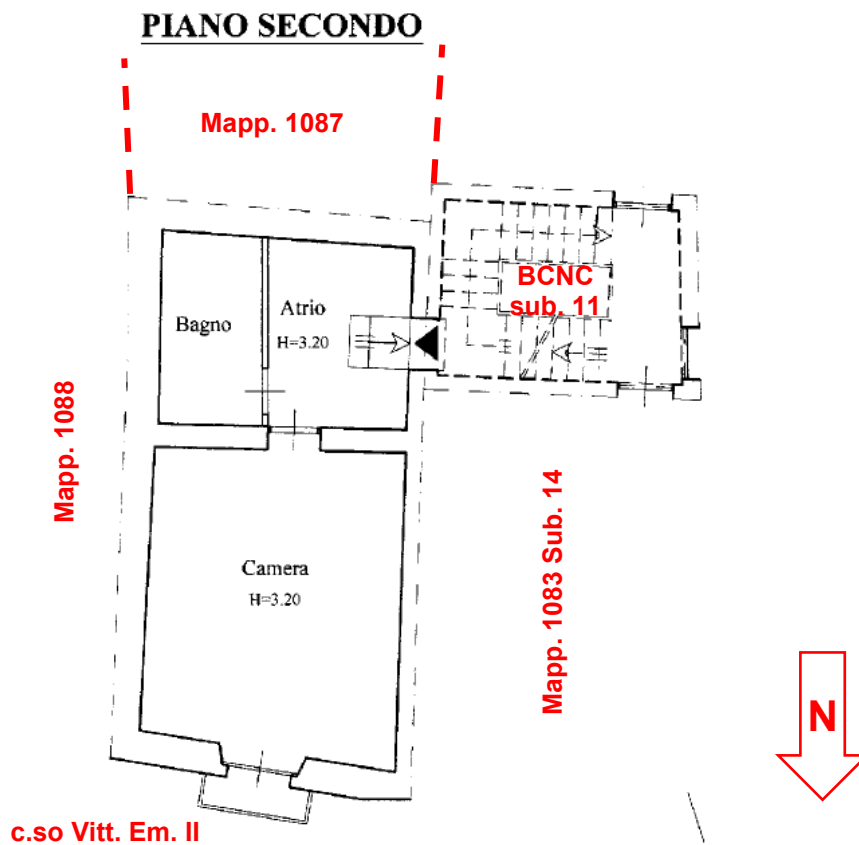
LOTTO 2. Planimetria catastale (fuori scala). Nord in basso
